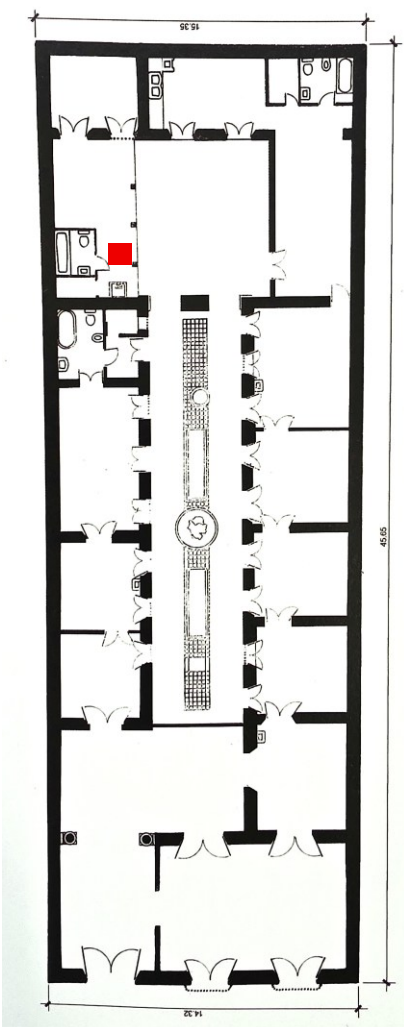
Plano de planta del inmueble de Medio 93 y la posición del brocal reconstruido del espacio de donde fueron extraídos los materiales. Foto del plano de planta modificado de García Santana y Larra-mendi (2009) y foto del autor
